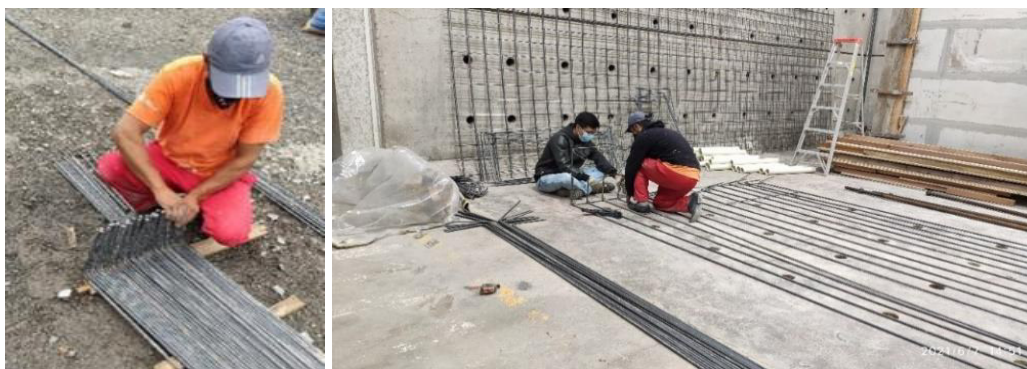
Replanteo, corte y localización de refuerzo de losa de cimentación en sitio.
